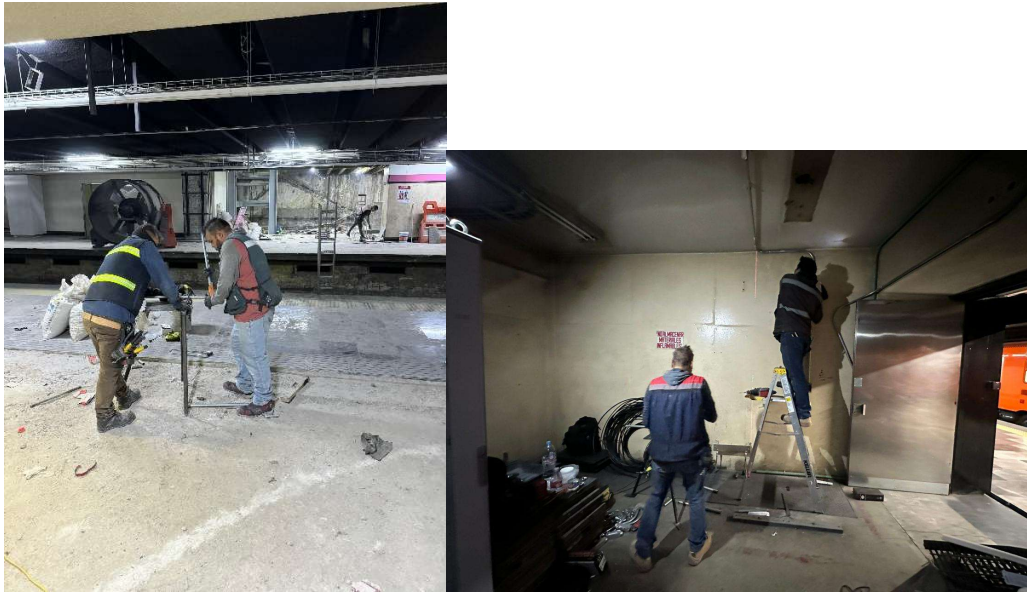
Habilitado de tubería conduit. Elaborado por el autor.
